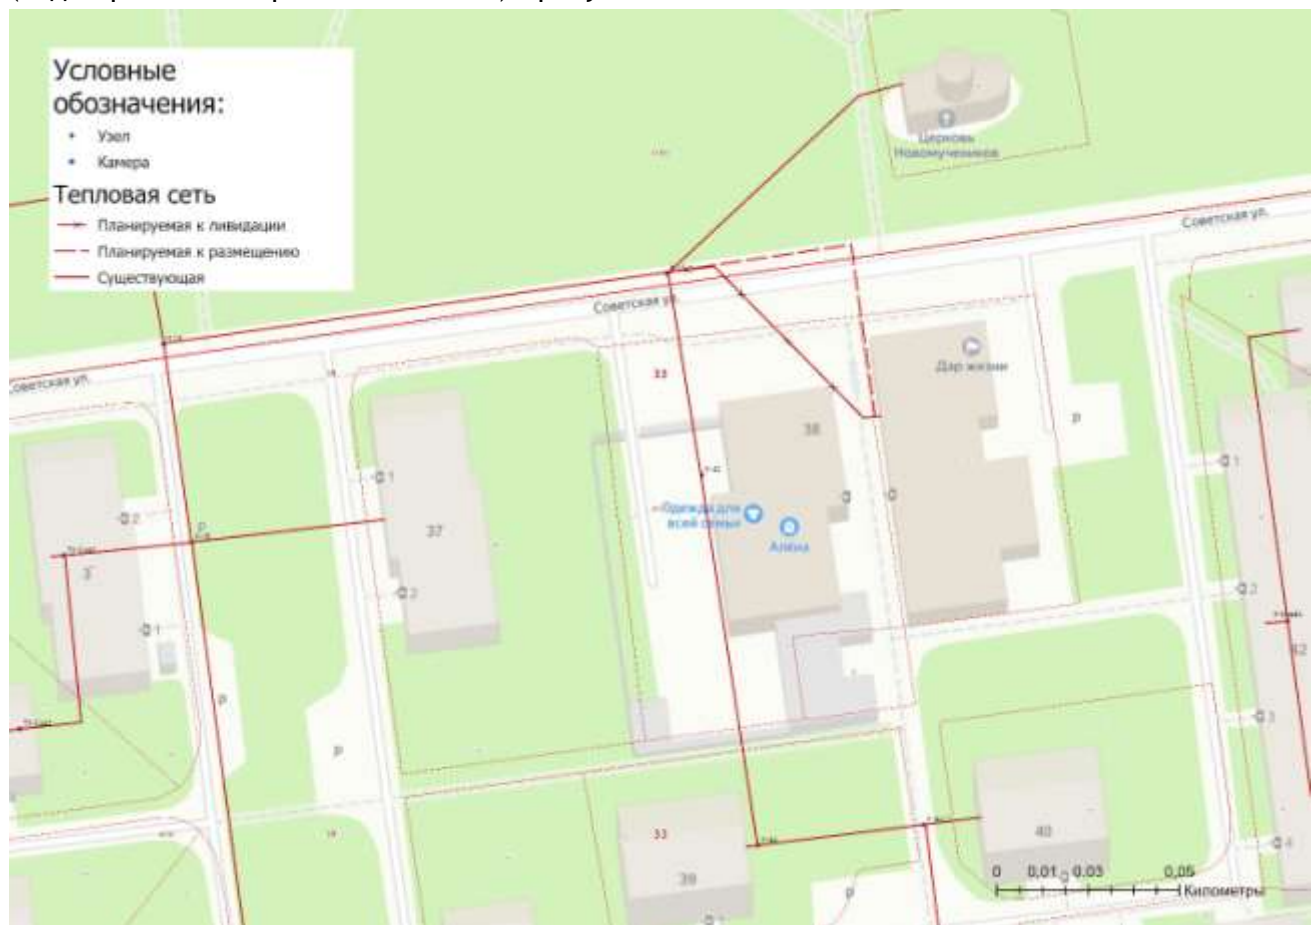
Схема перекладки участка тепловой сети в районе зданий д.38 по ул. Советская
